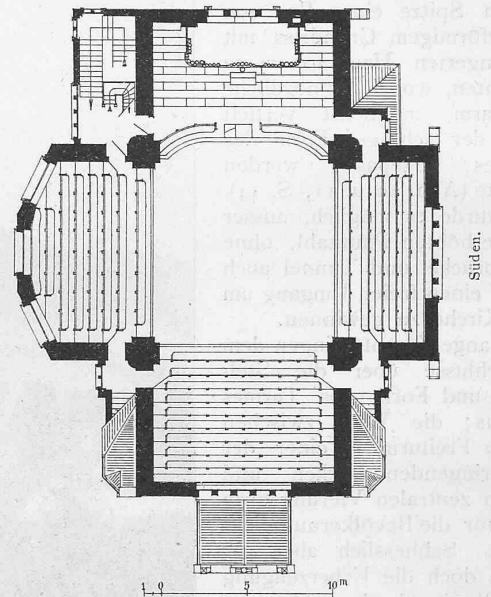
u. 11. Grundrisse vom Erdgeschoss und von der Emporenanlage. — Masstab 1 : 400.
